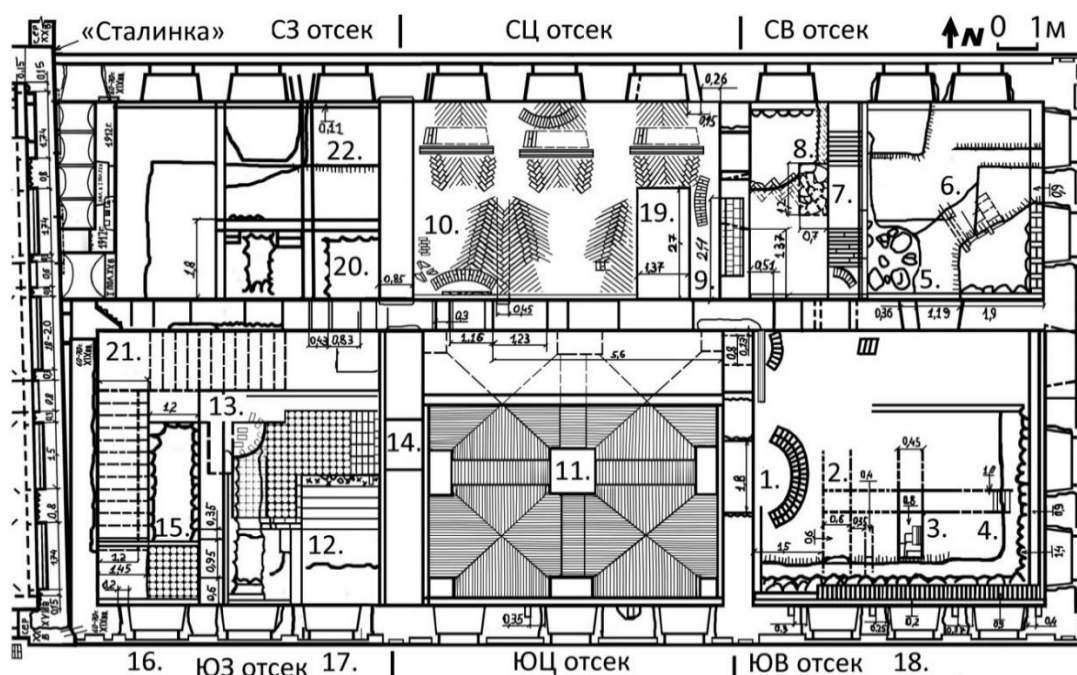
План «Отеля» на уровне подвала и фундаментов
